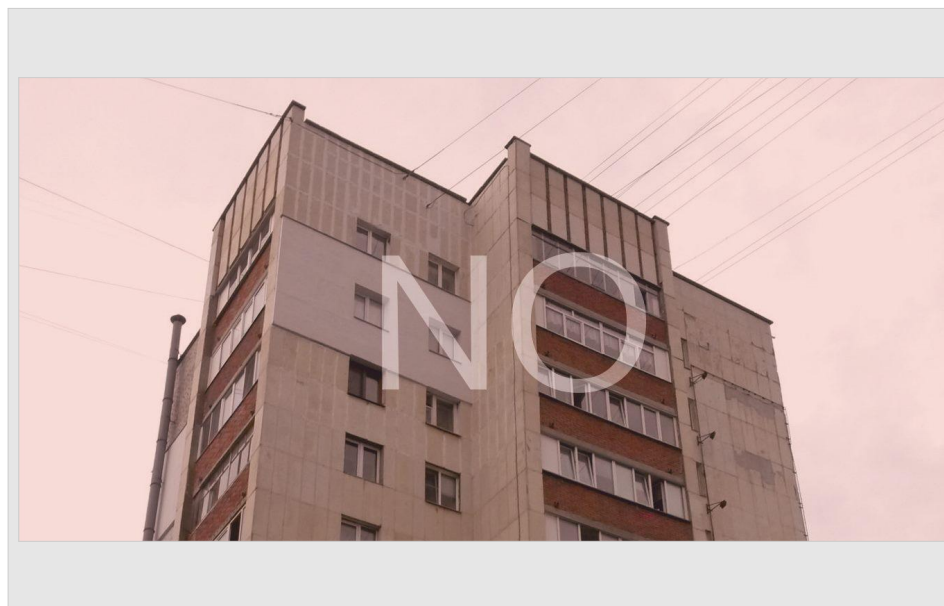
Отделка фрагмента фасада отличается от основной
